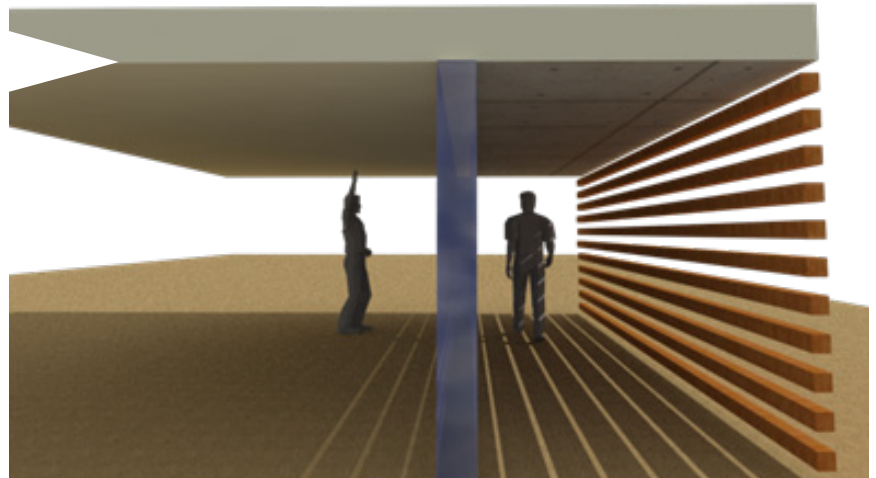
Losa Acero. Con el fin de utilizar la menor cantidad de concreto posible, las losas serán de este tipo.
